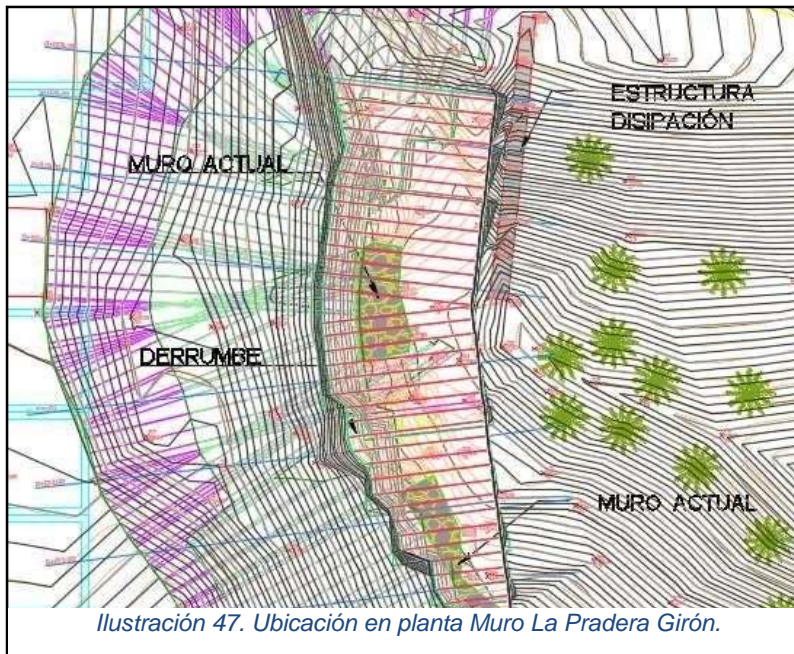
Ubicación en planta Muro La Pradera Girón.
